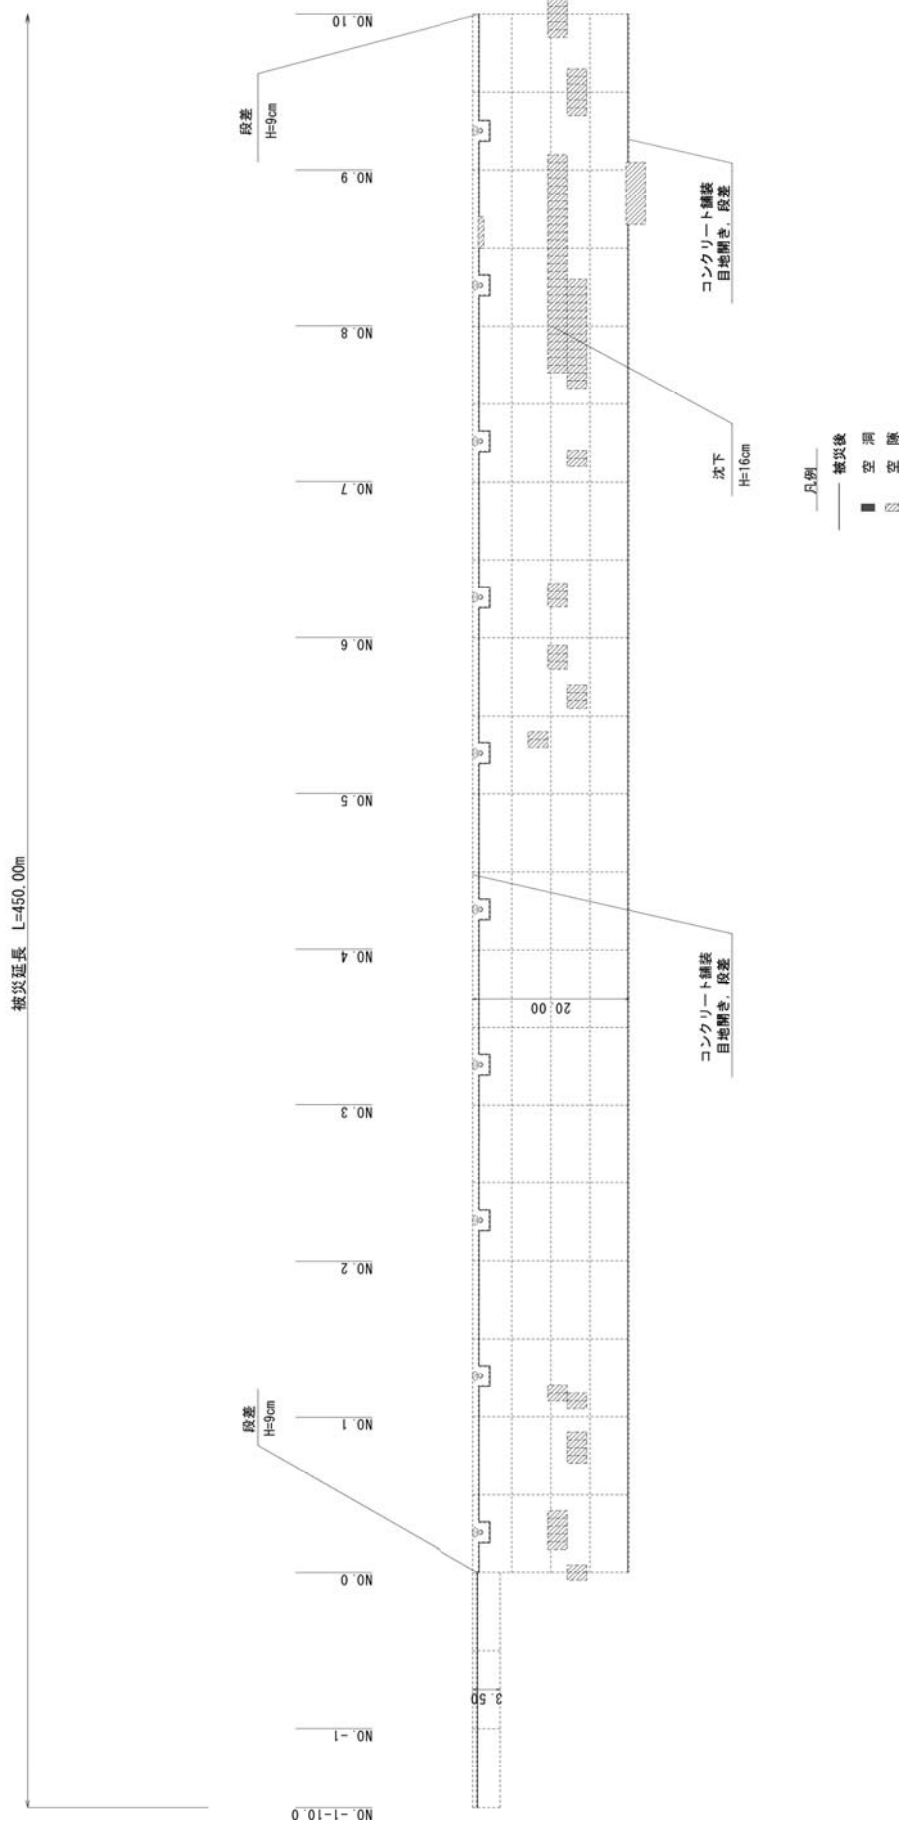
(a) 香椎パークポート地区-7.5m岸壁の被災状況平面図①
